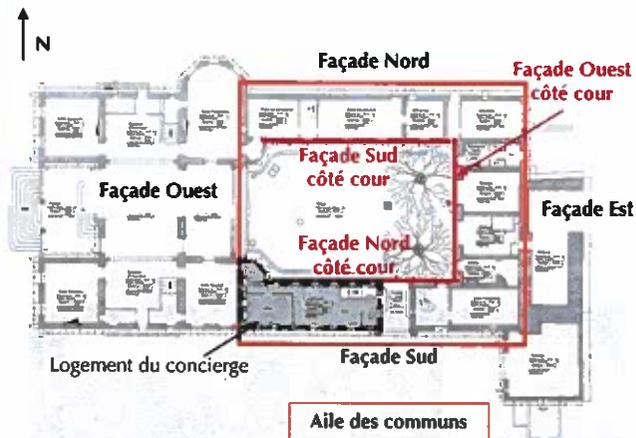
Localisation de l'aile des communs et nomenclature des façades, fond de plan transmis par l'architecte
